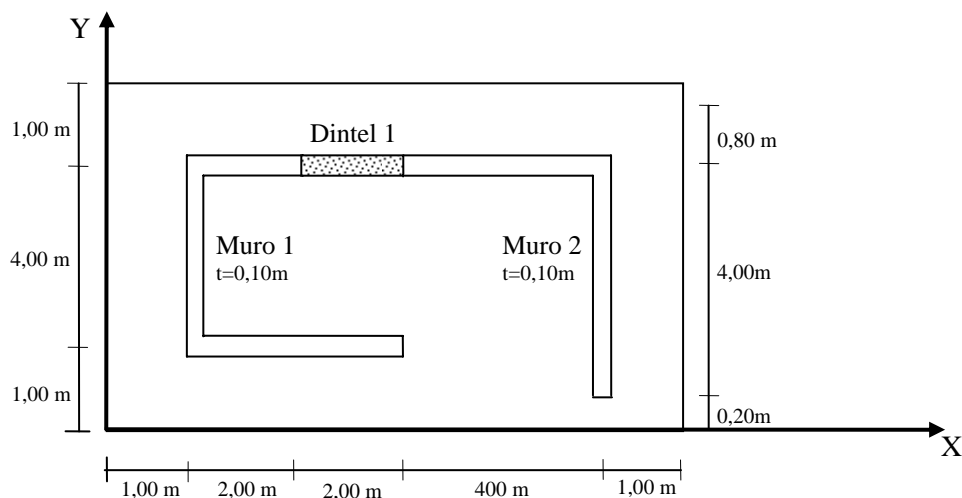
Geometría en Planta de los Muros Estructurales.
